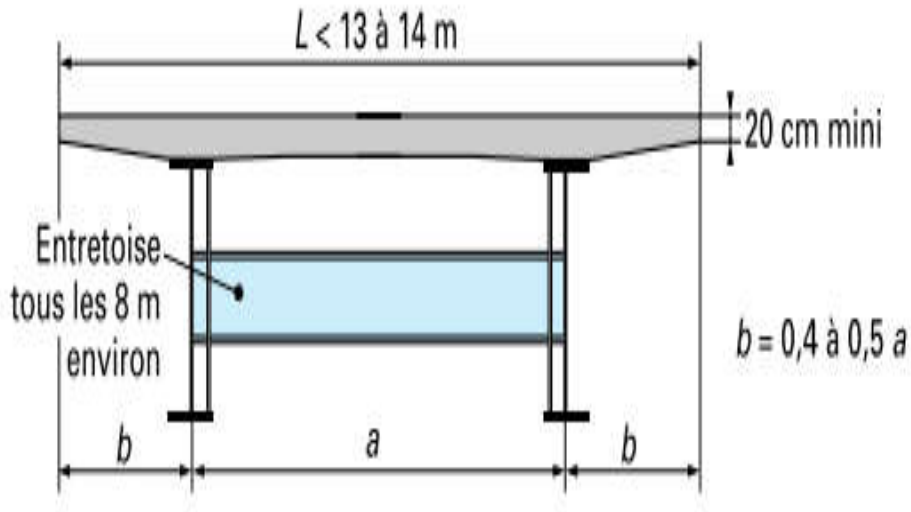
Coupe transversale d'un tablier bipoutre.
